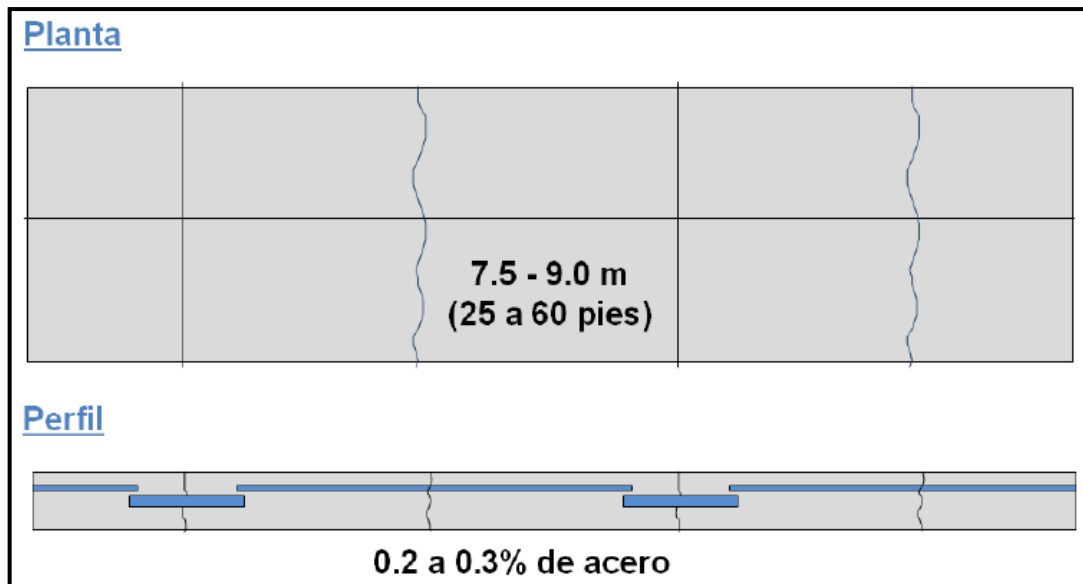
Esquema de pavimento de concreto reforzado con juntas. (Becerra, 2012)
